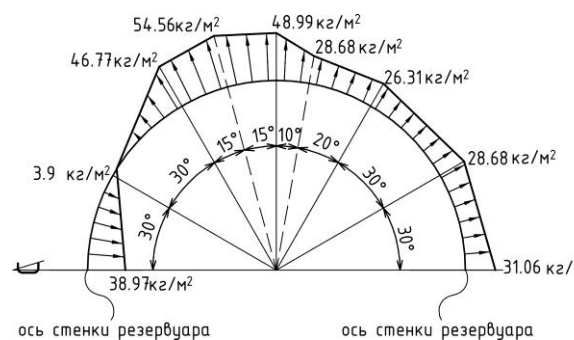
Схема приложения ветровой нагрузки на 8-й пояс стенки резервуара
